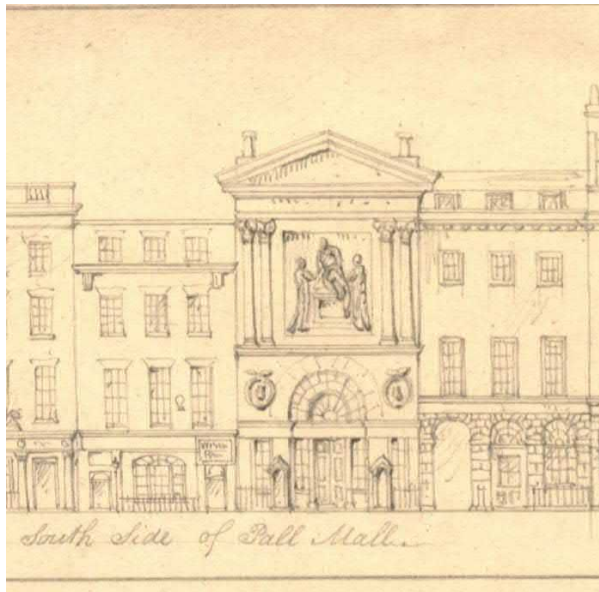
Detailansicht aus: John Coney, Elevation of the Houses on the South Side of Pall Mall, Arranged in Four Sections Underneath Each Other*, 1814.
